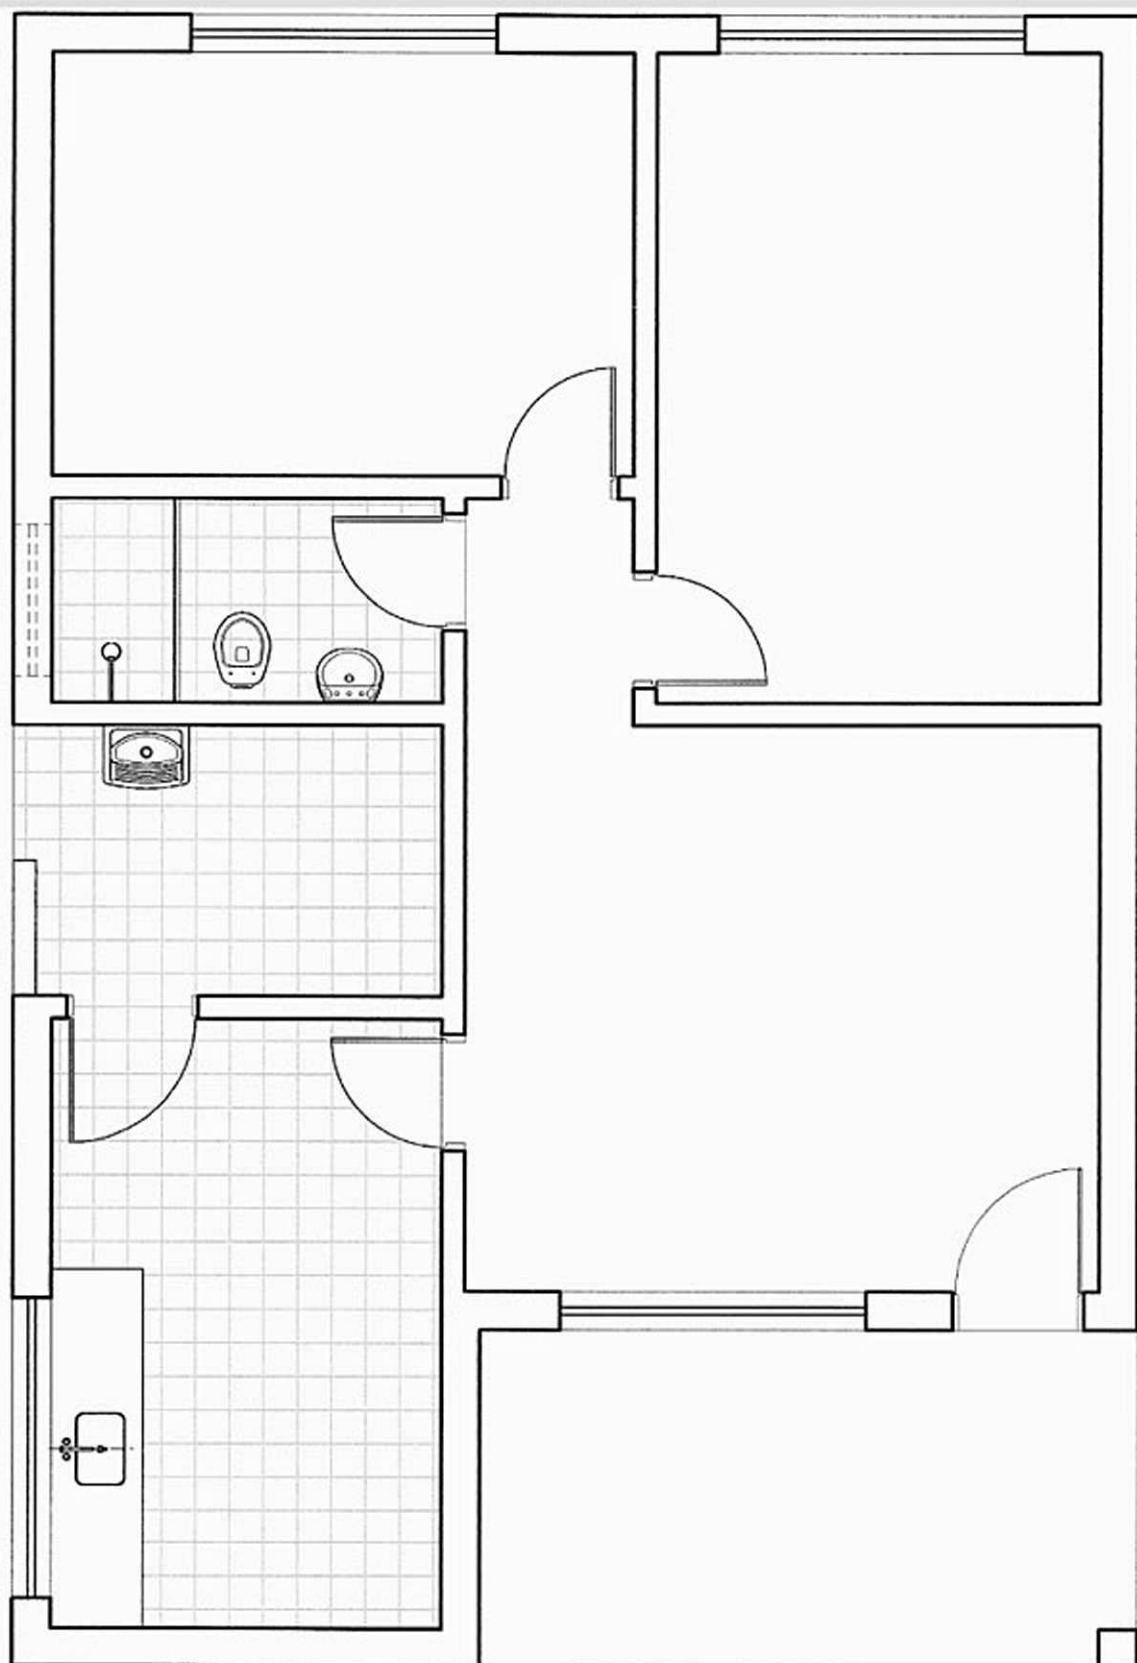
Planta simplificada (vista da parte inferior após o corte horizontal).
